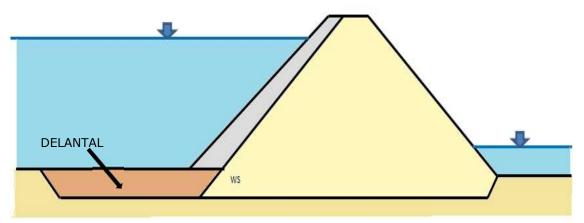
III.1.2.1 Tratamiento de la superficie de cimentación con delantal.
